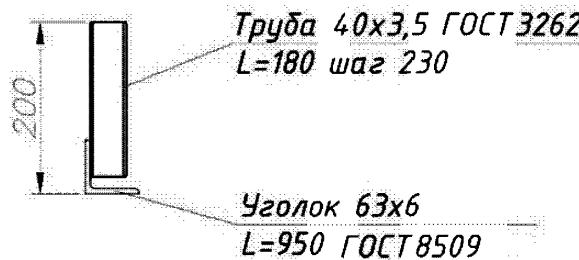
Закладная деталь под арматурные стержни
